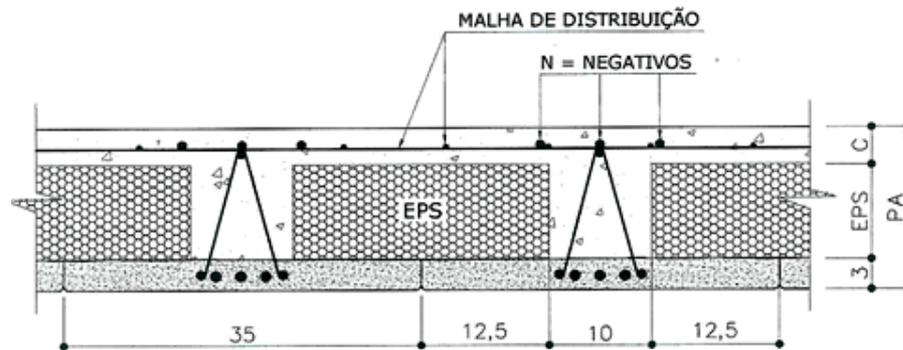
Detalhamento laje nervurada com mesa inferior (Lajes Anhanguera)
